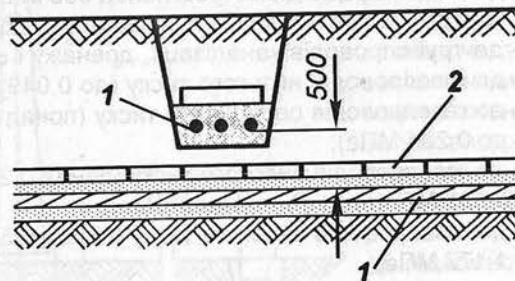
Перетин КЛ трубо-, водо- і газопроводів
